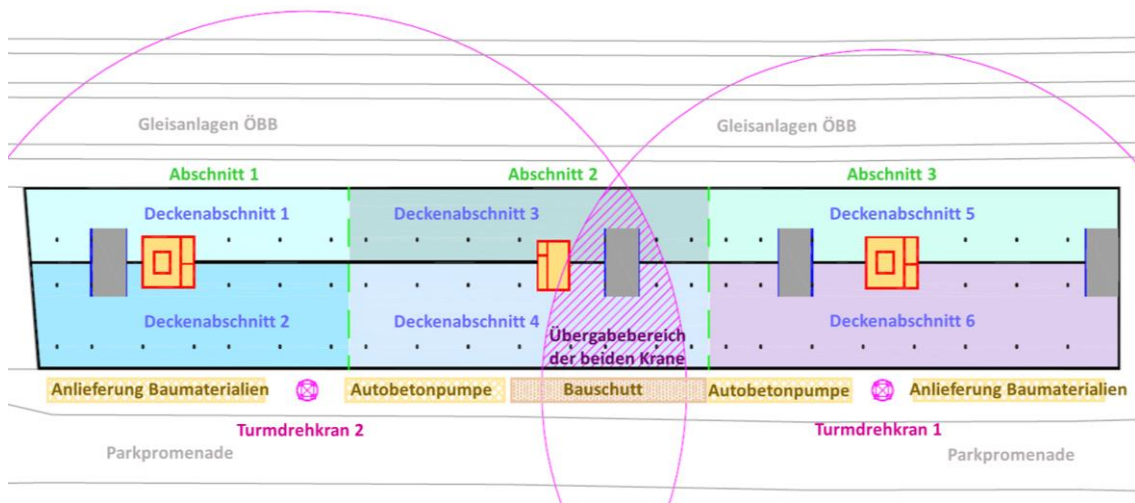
Grundriss des Parkdecks mit Darstellung der Deckenabschnitte
